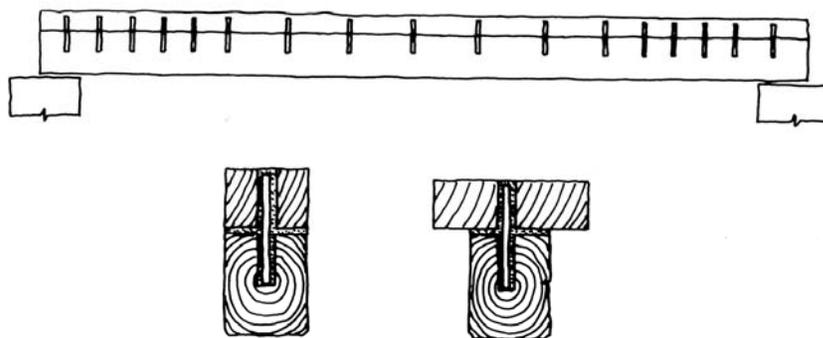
Aumento de la sección de la viga con el acoplamiento de una pieza encolada.
